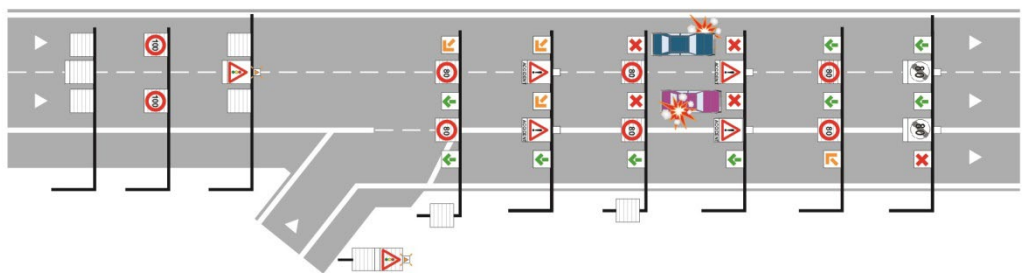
33.5 BAU fermée : événement sur la voie normale et la voie de dépassement (exploitation locale de la BAU).
